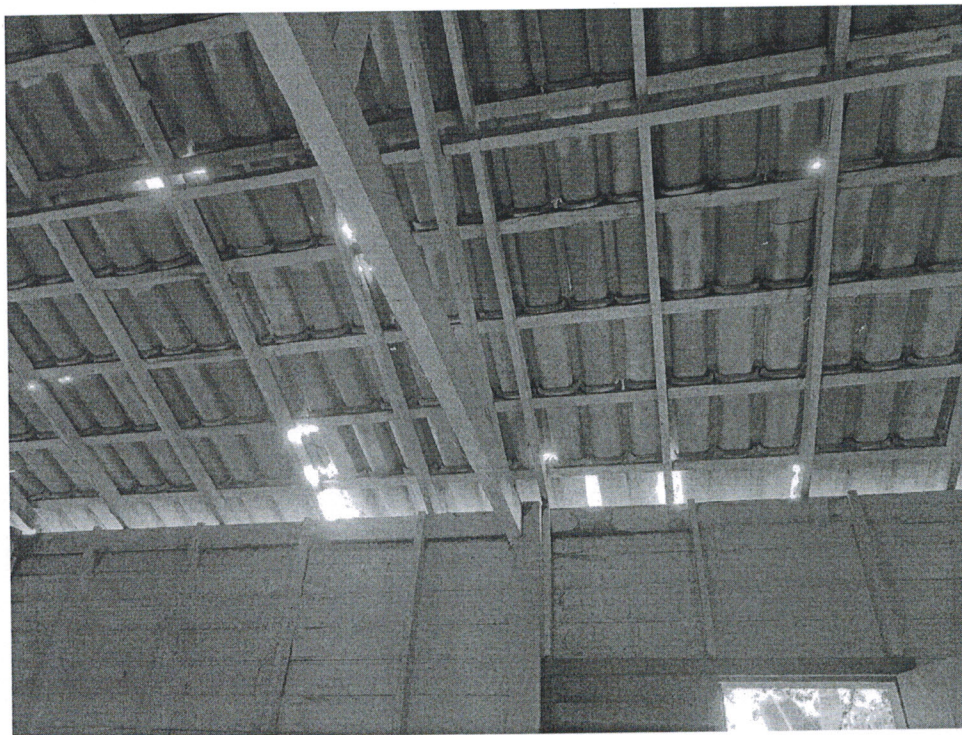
Telhado com goteiras e ripas deterioradas.
